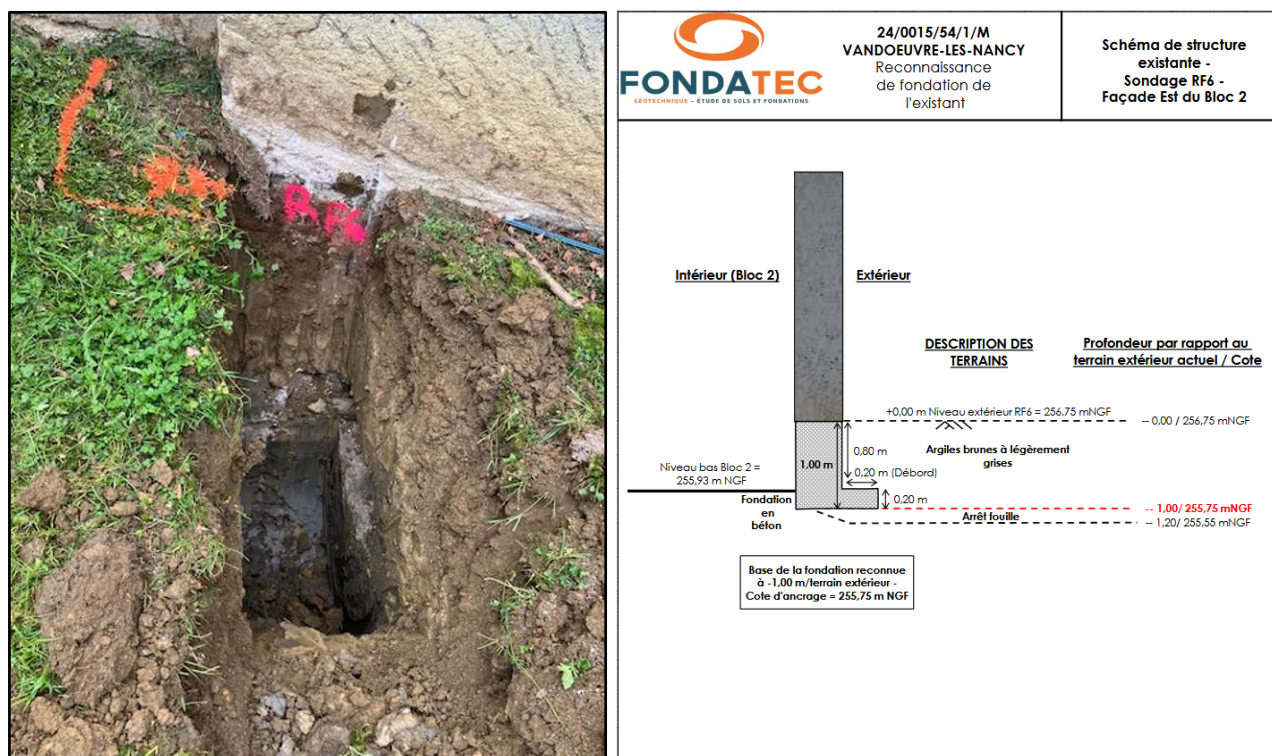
Photographie et coupe de la reconnaissance de fondation RF6 du bloc 2
